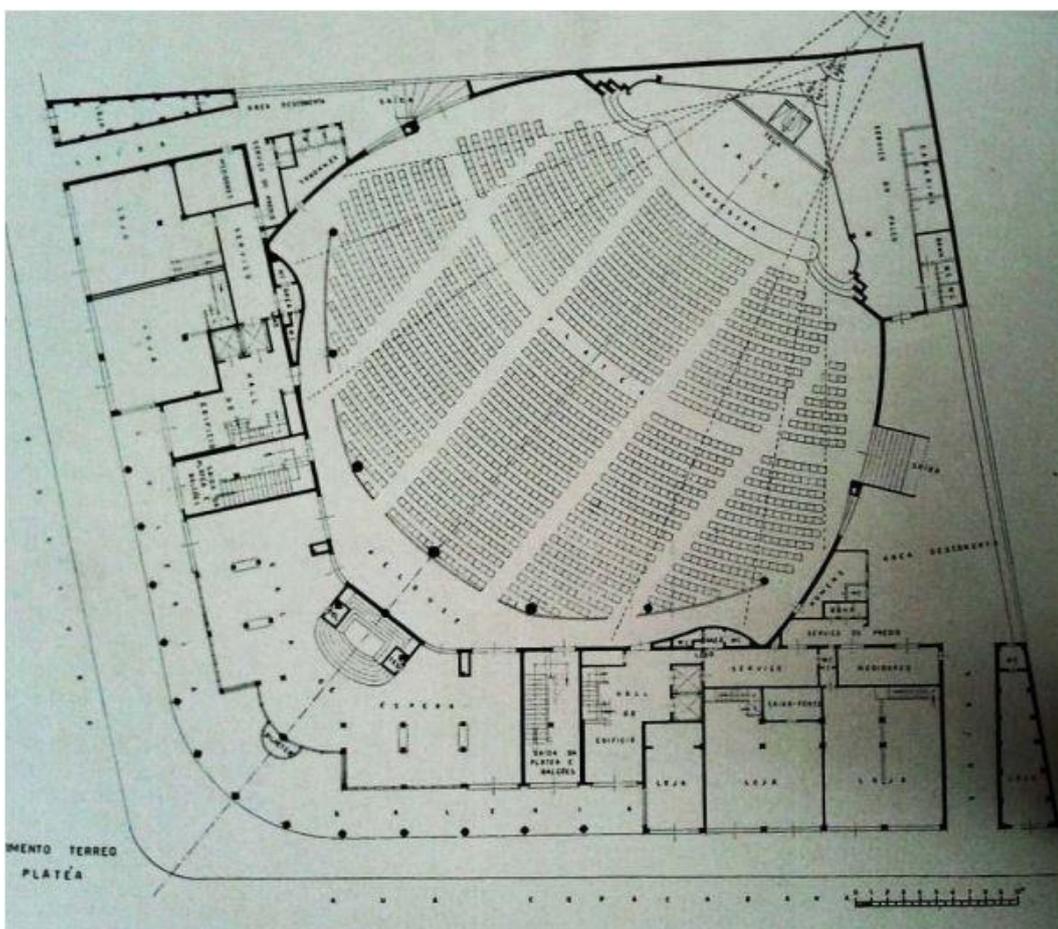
Planta do pavimento térreo do Cinema Roxy - Cinema Roxy (F. Revista Arquitetura e Urbanismo em 1939 – Bruno Sarmento dos Santos).
